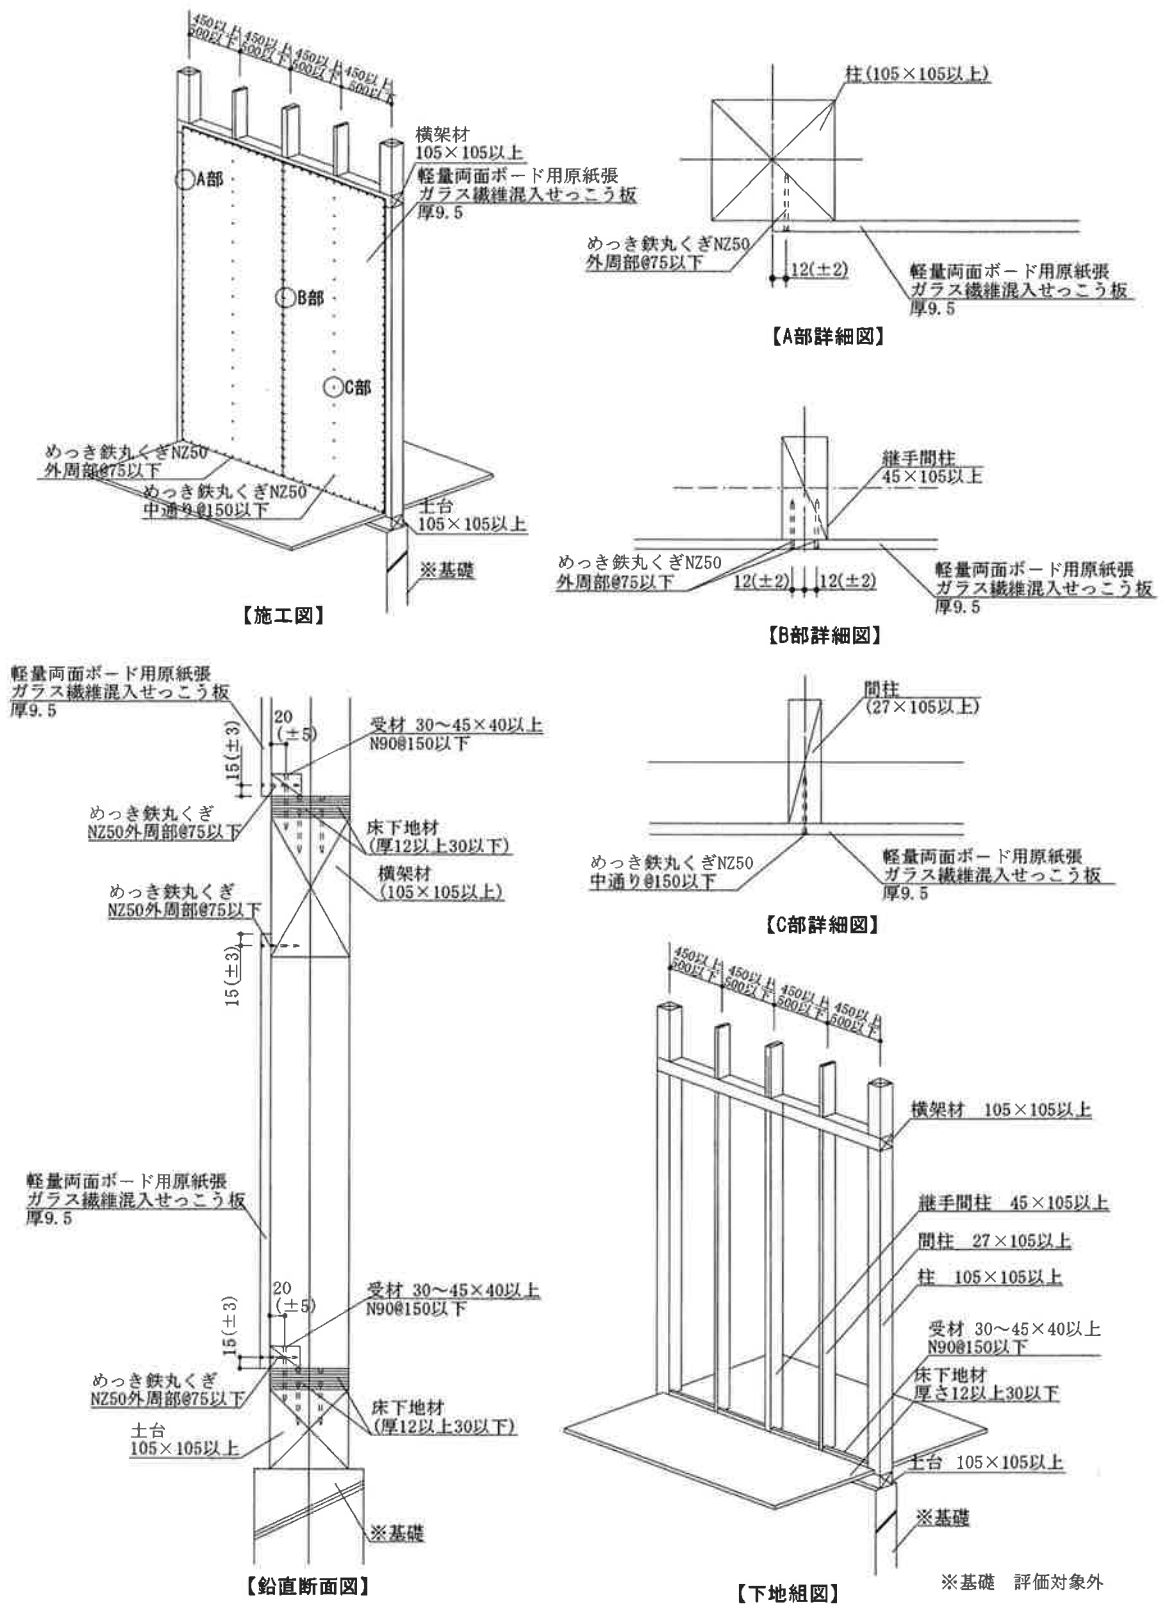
施工詳細図：1枚張りの場合 (寸法単位：mm)
